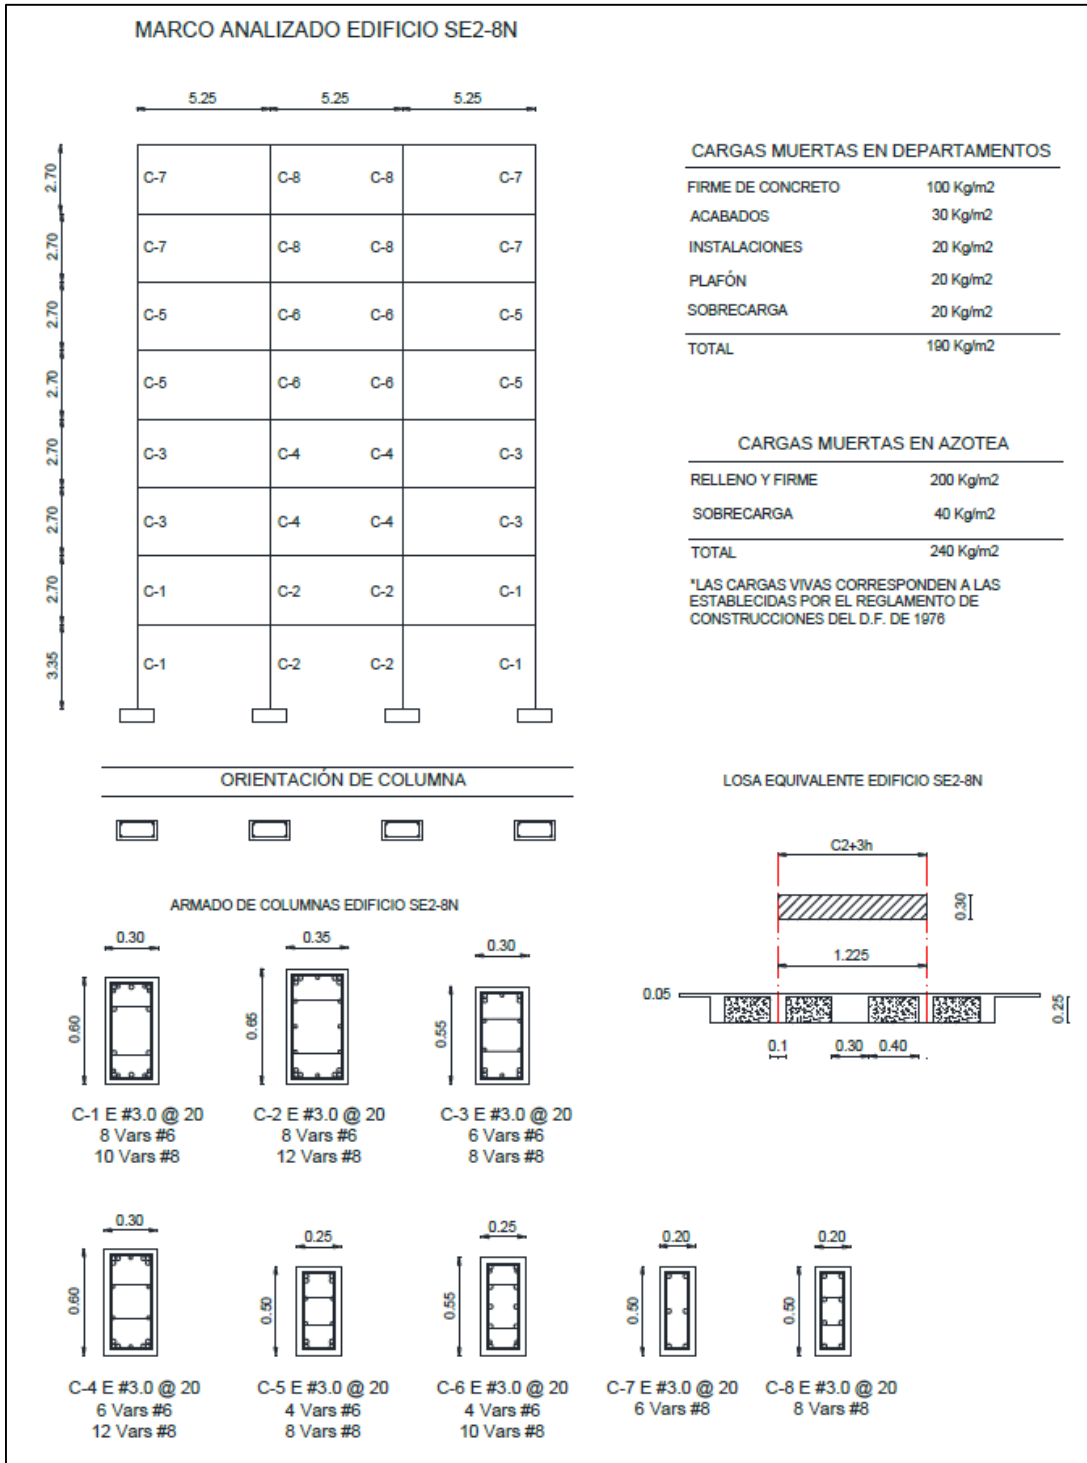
Detalles estructurales y cargas del edificio SE2-8N usadas en el análisis no-lineal.
